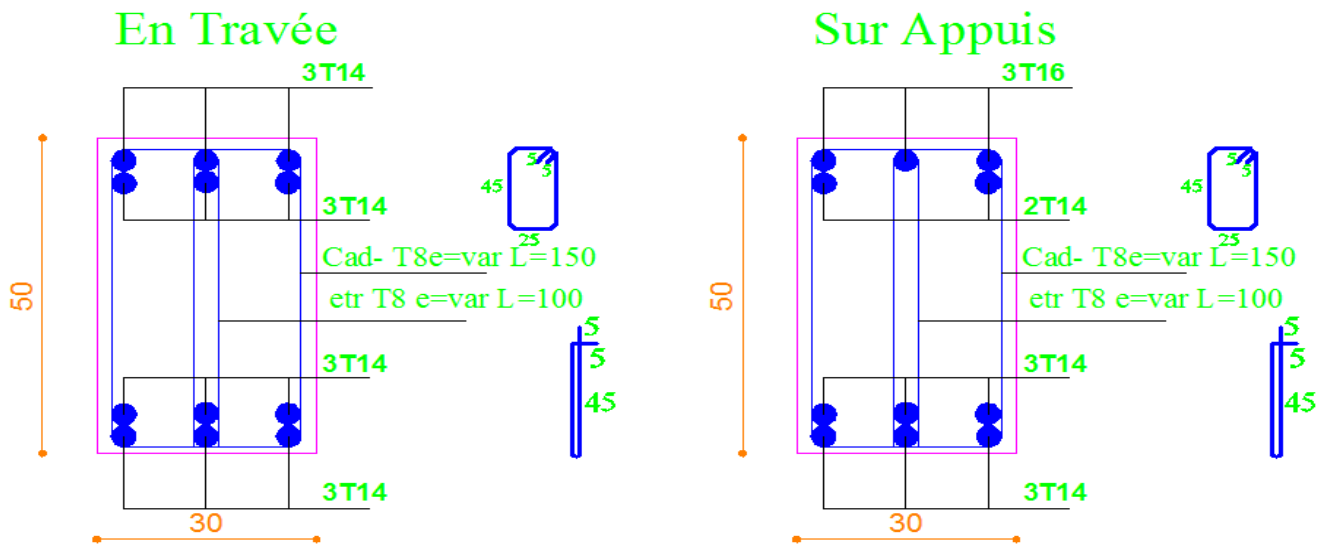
Schéma de ferrailage des poutres longitudinales et transversales.
